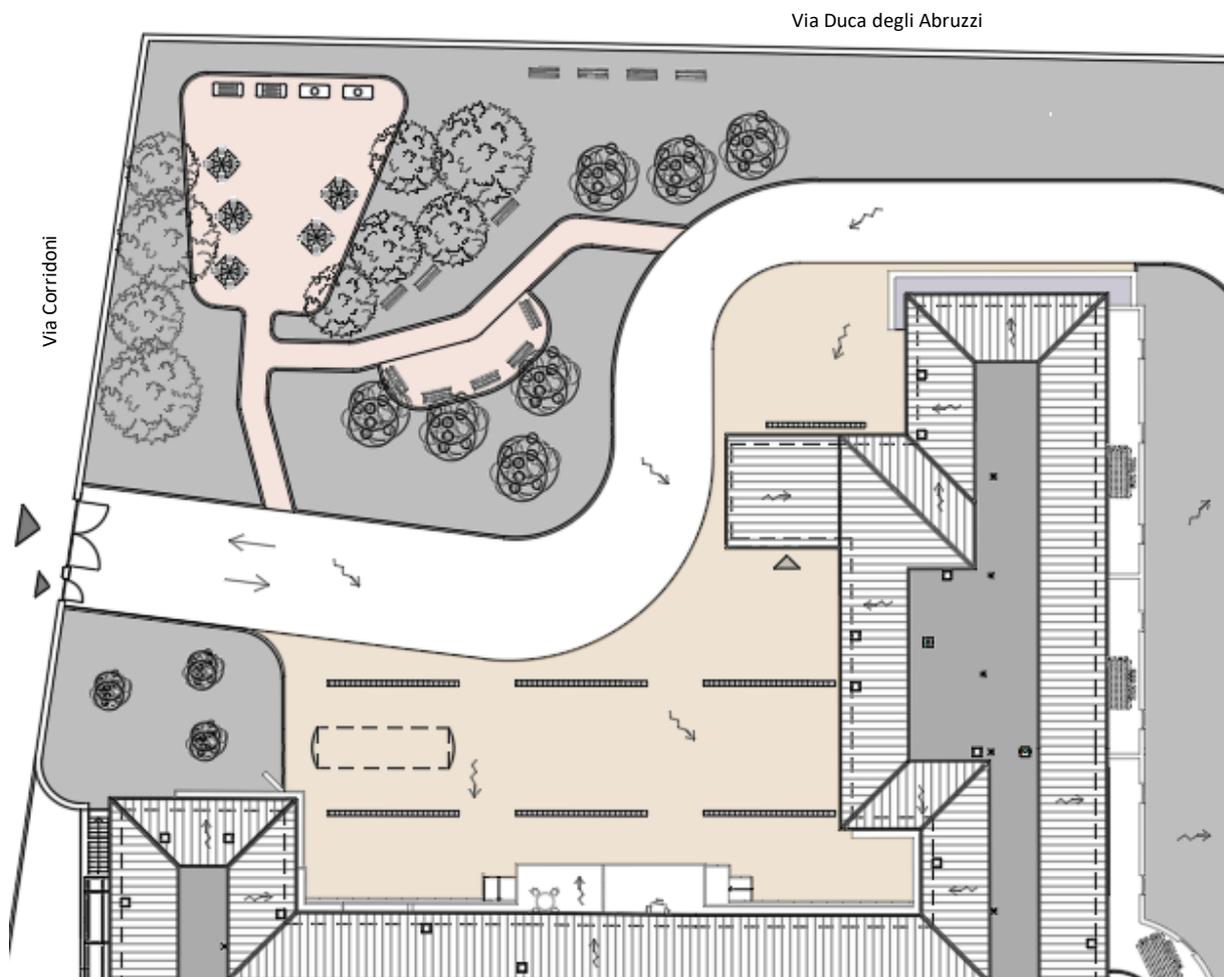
Stralcio di tavola "planimetria lotto di progetto", angolo tra via Corridoni e via Duca degli Abruzzi.
